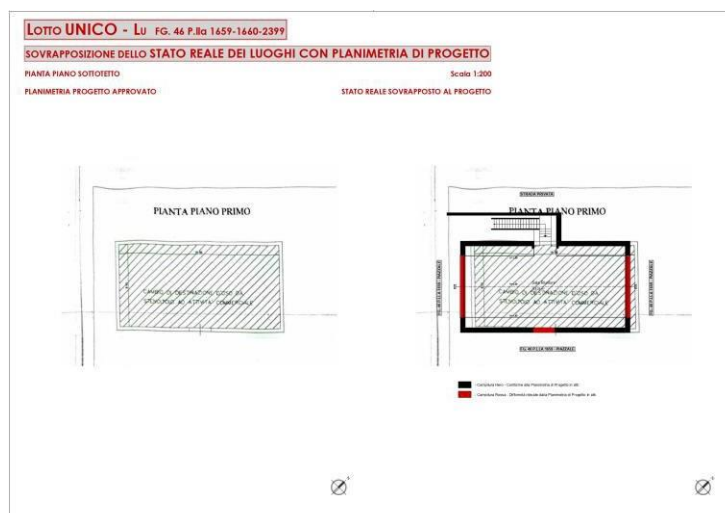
Raffronto stato reale con planimetria di Progetto LOTTO LU – S. (ALL. 08).
